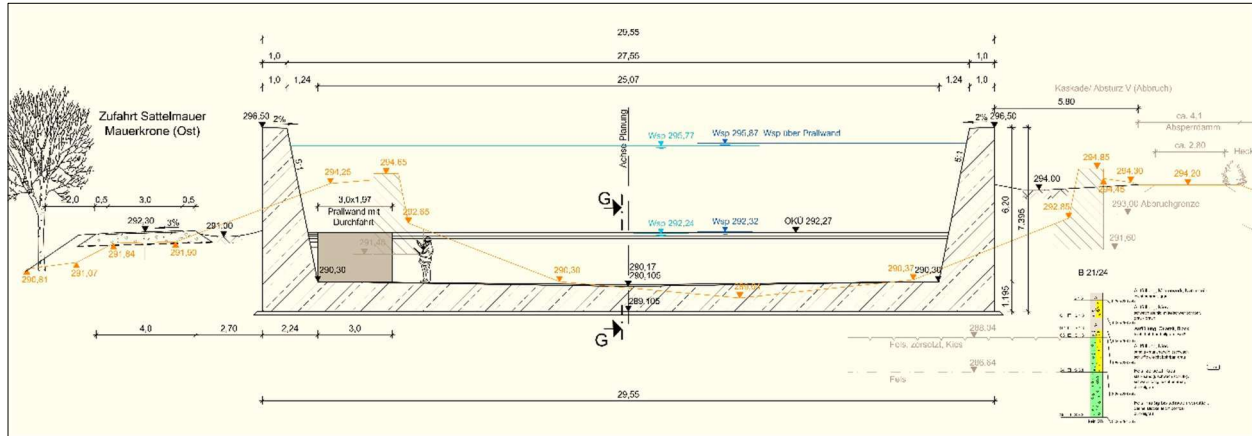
Variante A1/B1; HWE - unterer Abschnitt - Draufsicht; Ausschnitt aus Plan 423 HWE-Grundriss, Schnitt A
